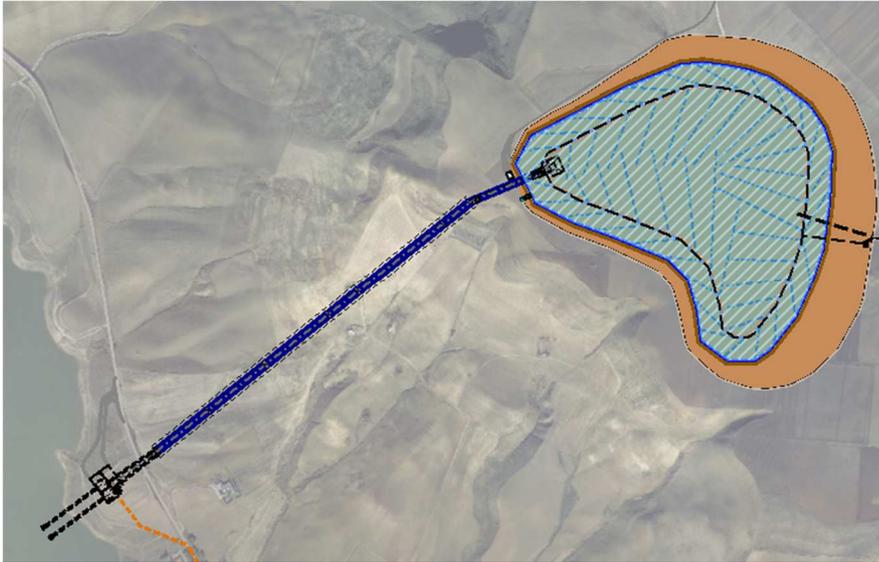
Estratto della planimetria di progetto di cui all'Elaborato PD-EP.3.1 del Progetto Definitivo.
